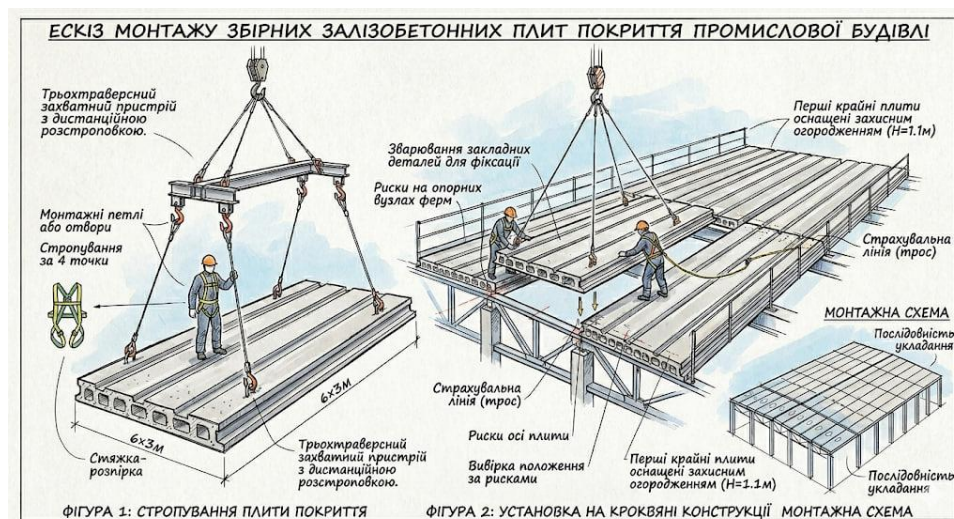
Ескіз монтажу збірних залізобетонних плит покриття.
